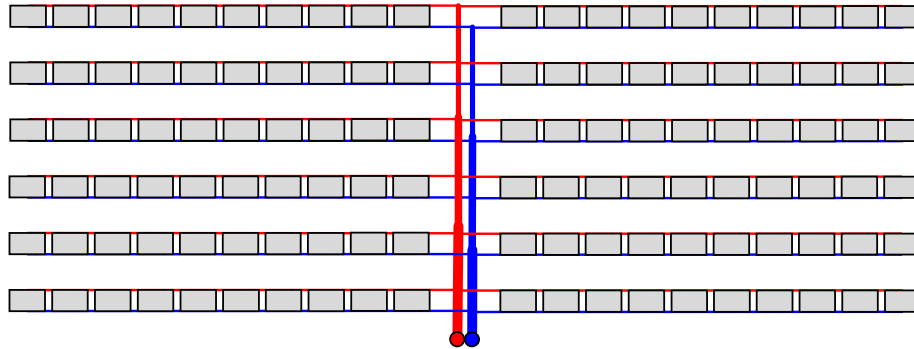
Kollektorfeld mit mittigem Anschluss.
